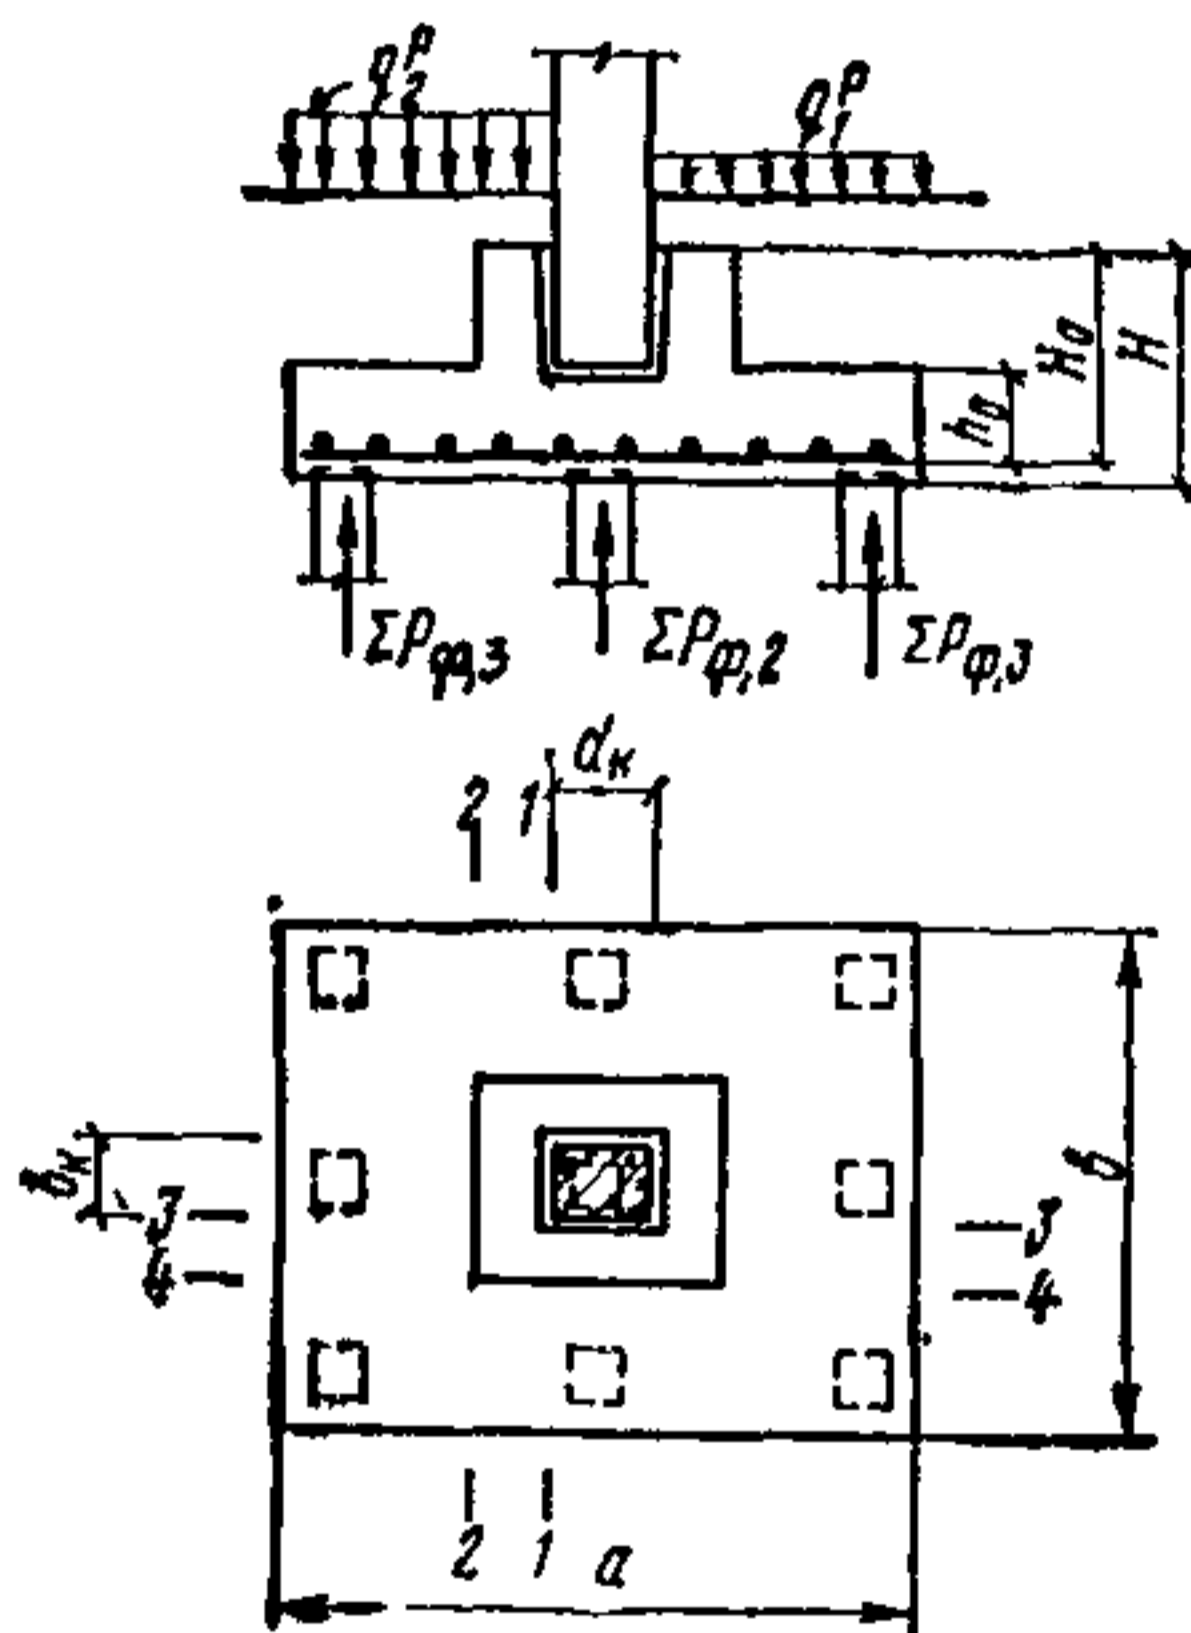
Расчетная схема для определения арматуры подошвы ростверка
